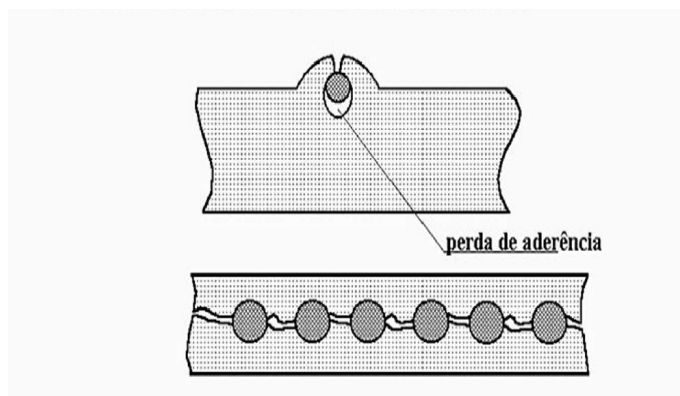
Fissuração caracterizada pela perda de aderência entre o aço e o concreto.
